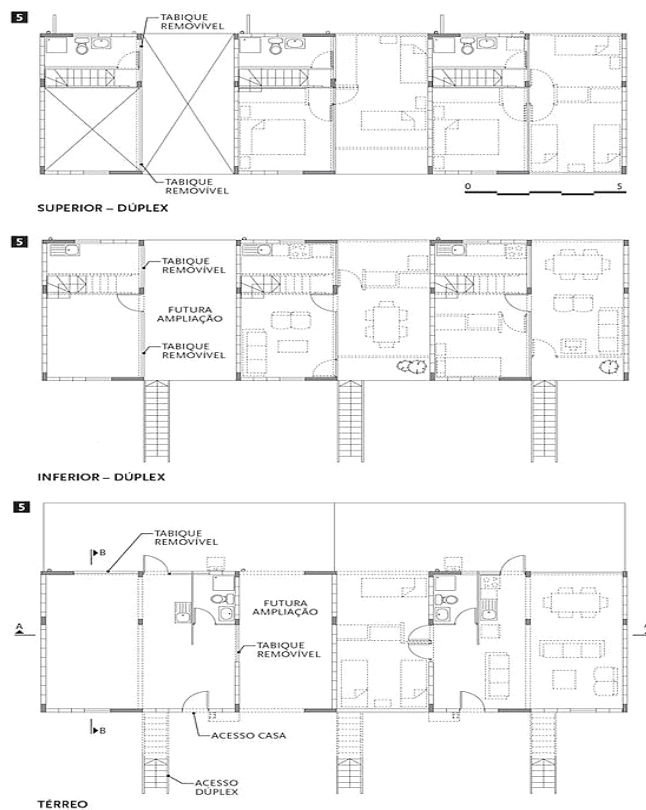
Planta do Quinta Monroy - Fonte: Revista AU.
